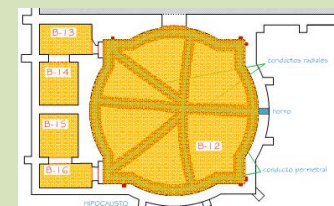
Planta de la habitación B-12 y las colindantes al oeste.
